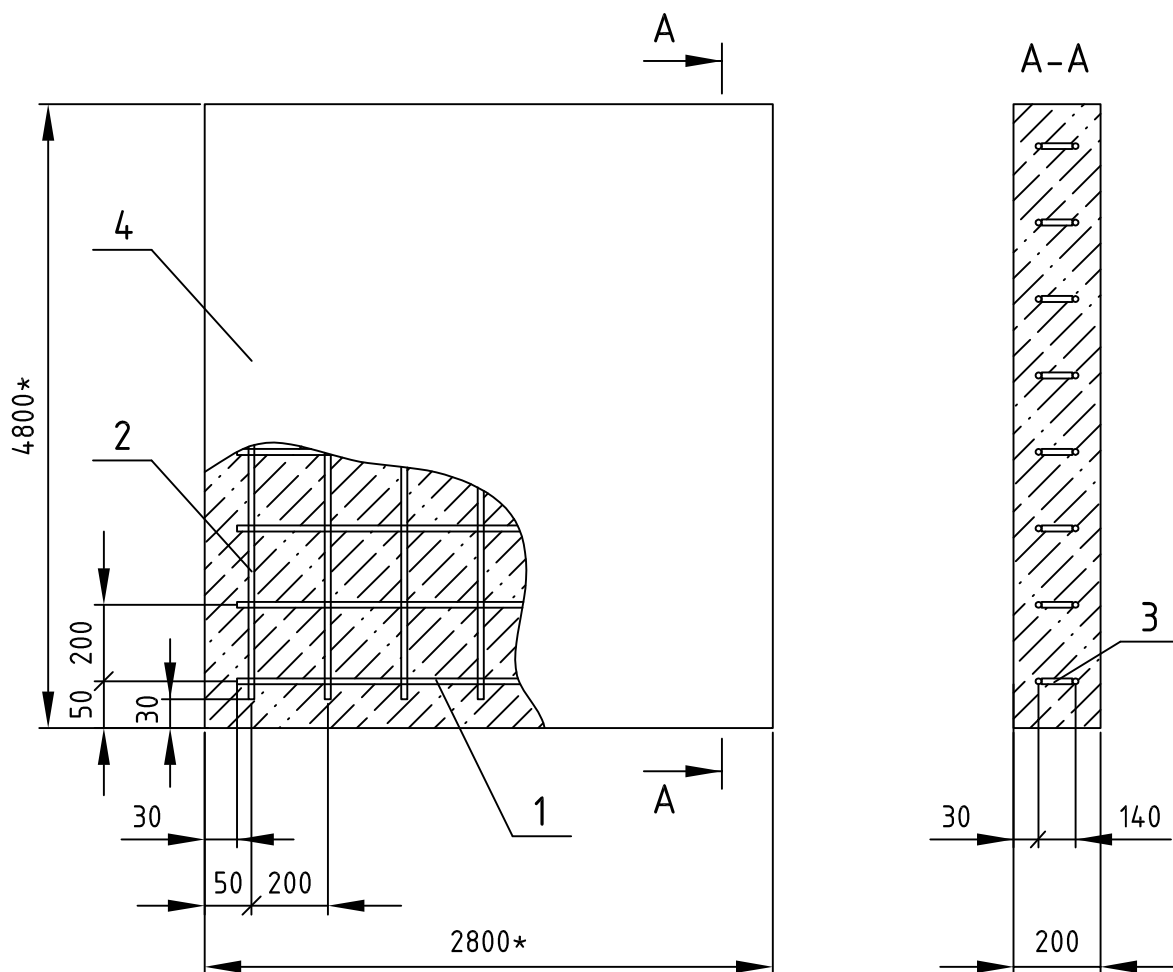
Рекомендуемая подготовка фундамента для установки
